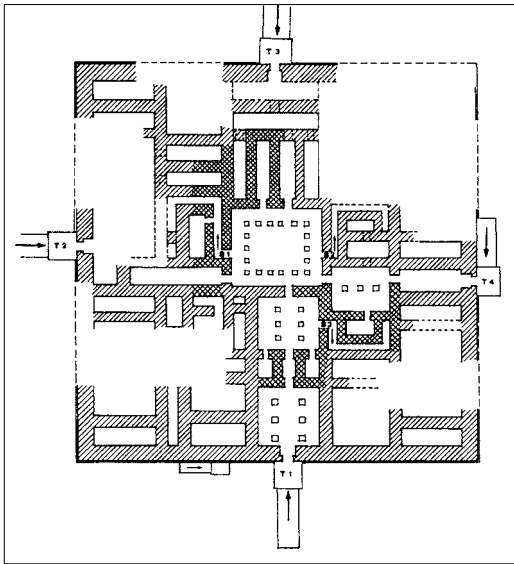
(links): Palast 1500 am Gebel Barkal; ein Beispiel für den klassischen kuschitischen Residenztyp mit zentralem Hof/Halle. Der Grundriss zeigt vor allem Fundamentmauern, die die Terrassierung hielten. Neben einem Erdgeschoss mit Zugangskorridor, Hof und Repräsentationsräumen besaß der Palast ein Obergeschoss, in dem weitere (Wohn?) Räume um den zentralen Lichthof gruppiert waren.
